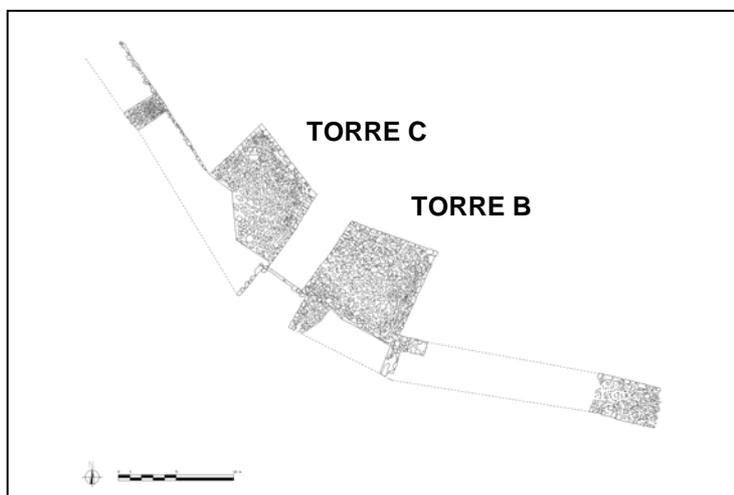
Planimetria delle Torri B e C (Porta Est).
